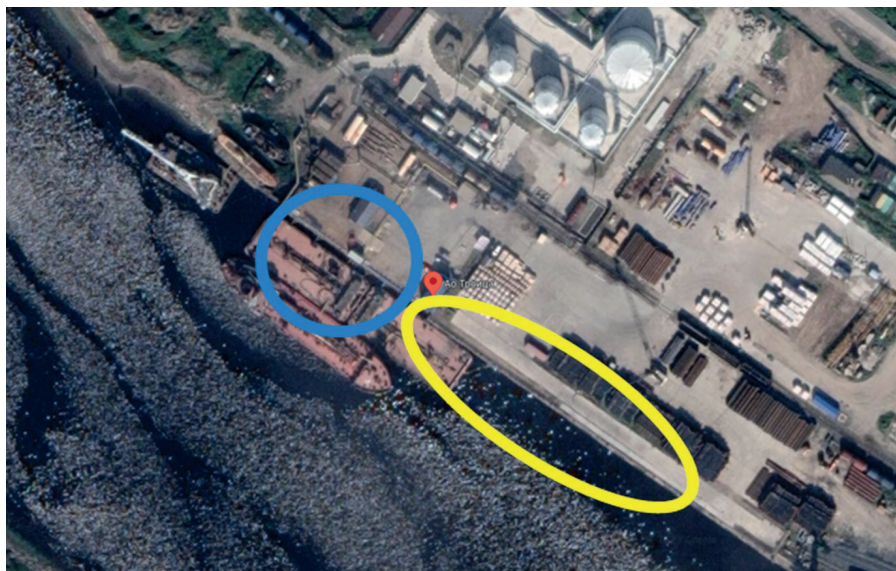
Ситуационный план причала перегрузки нефтепродуктов (отмечен в виде круга) и железобетонного причала с железнодорожными и подкрановыми путями (отмечен в виде овала)
